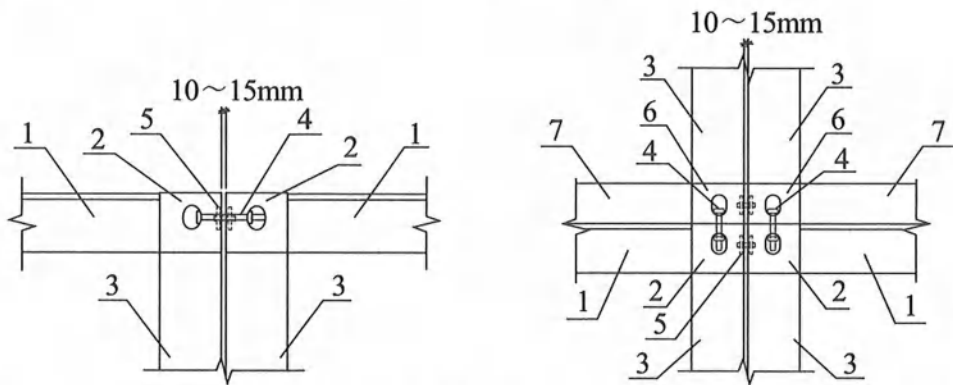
顶层立面节点示意图 图 5.3.1-2 中间层立面节点示意图
